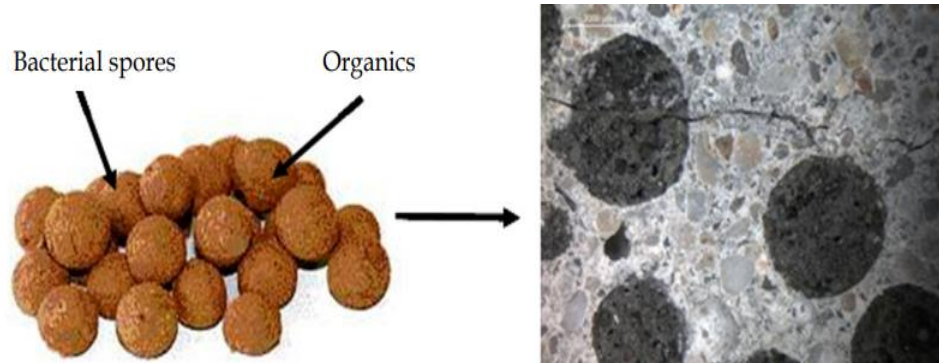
Partículas de arcilla expandida y se aprecia el concreto fisurado.
